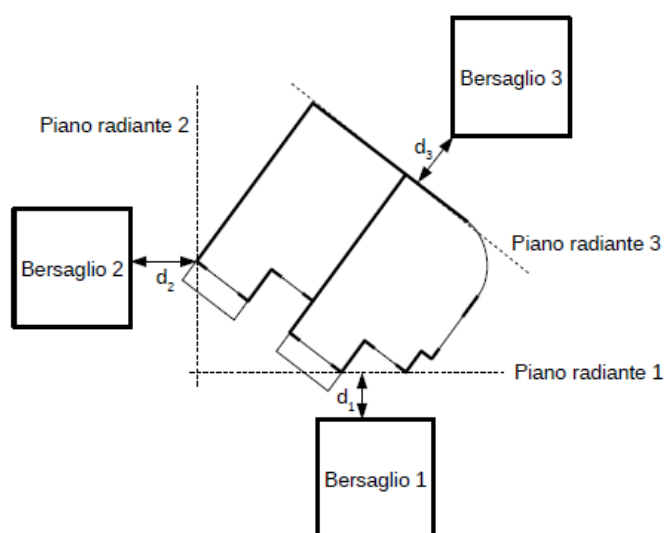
Determinazione del piano radiante, vista in pianta delle costruzioni.
